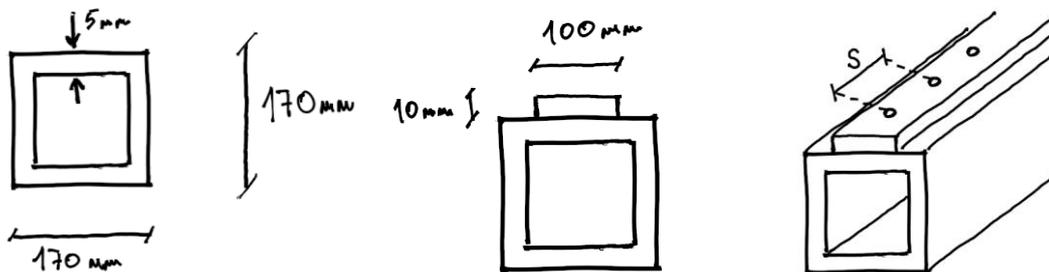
Sección de las vigas de la estructura a) antes de reforzar, b) con el suplemento ya incorporado, c) con la separación indicada de los pernos
